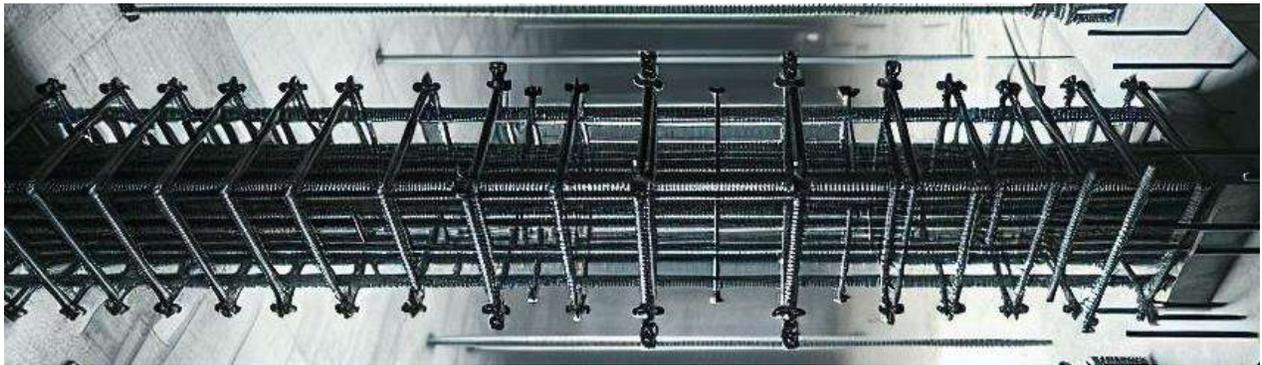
OpenAI. (2025). Escarificación en muros para colocación de traves, imagen generada por IA.
